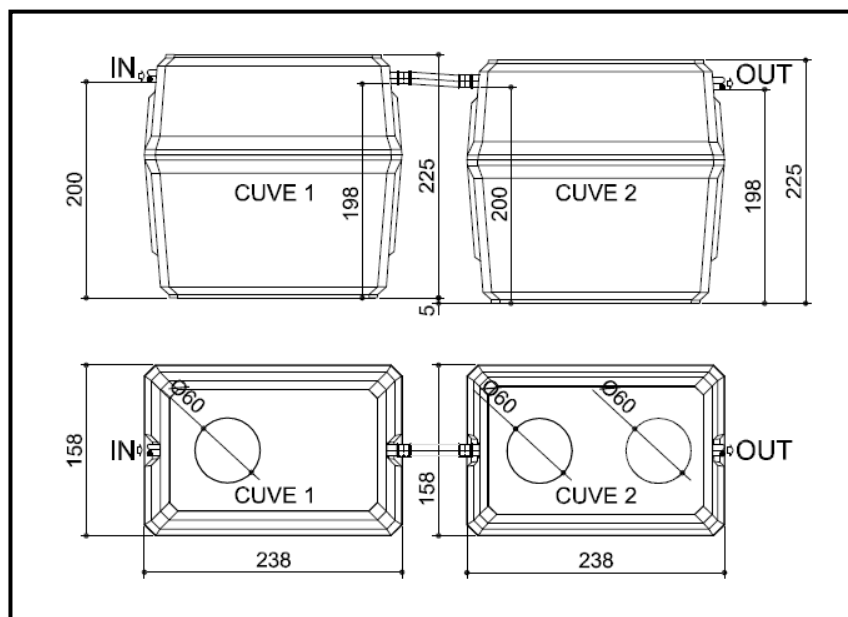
Plan d'encombrement des Oxyfix® C-90 10-11 et 12-14 (2)
